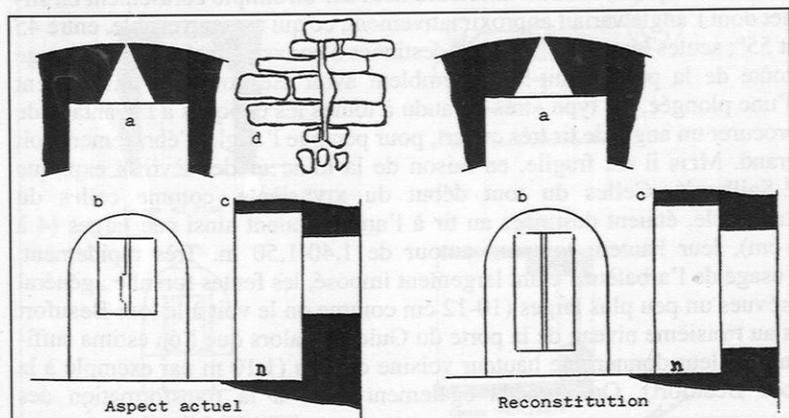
Porte du Guichet : relevé de l'archère frontale du rez-de-chaussée de la tour Ouest
